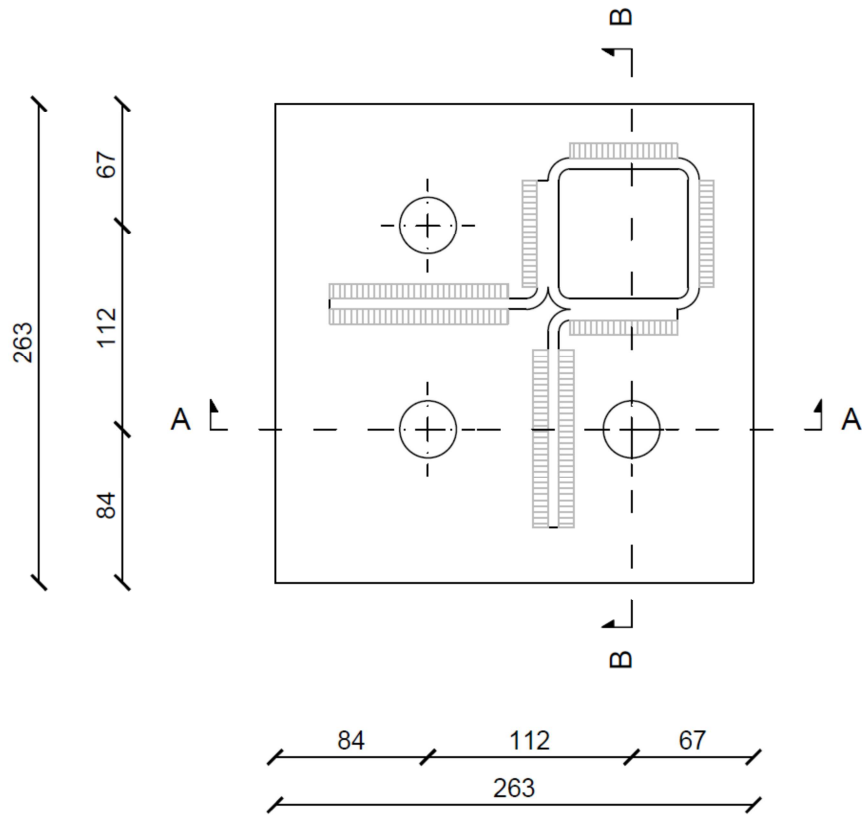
Vista in pianta del collegamento a terra dei montanti ad L
